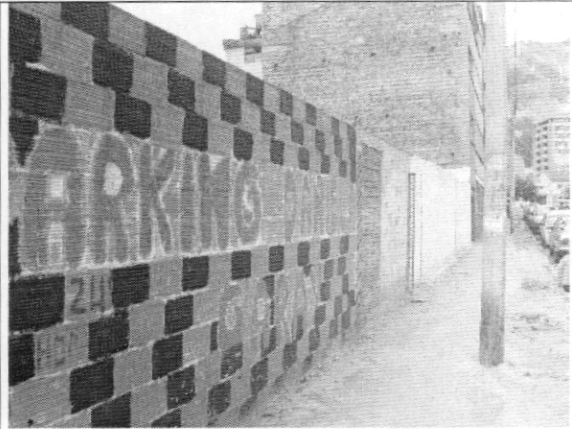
Aspecto del muro de cerramiento después de la intervención de reparación
